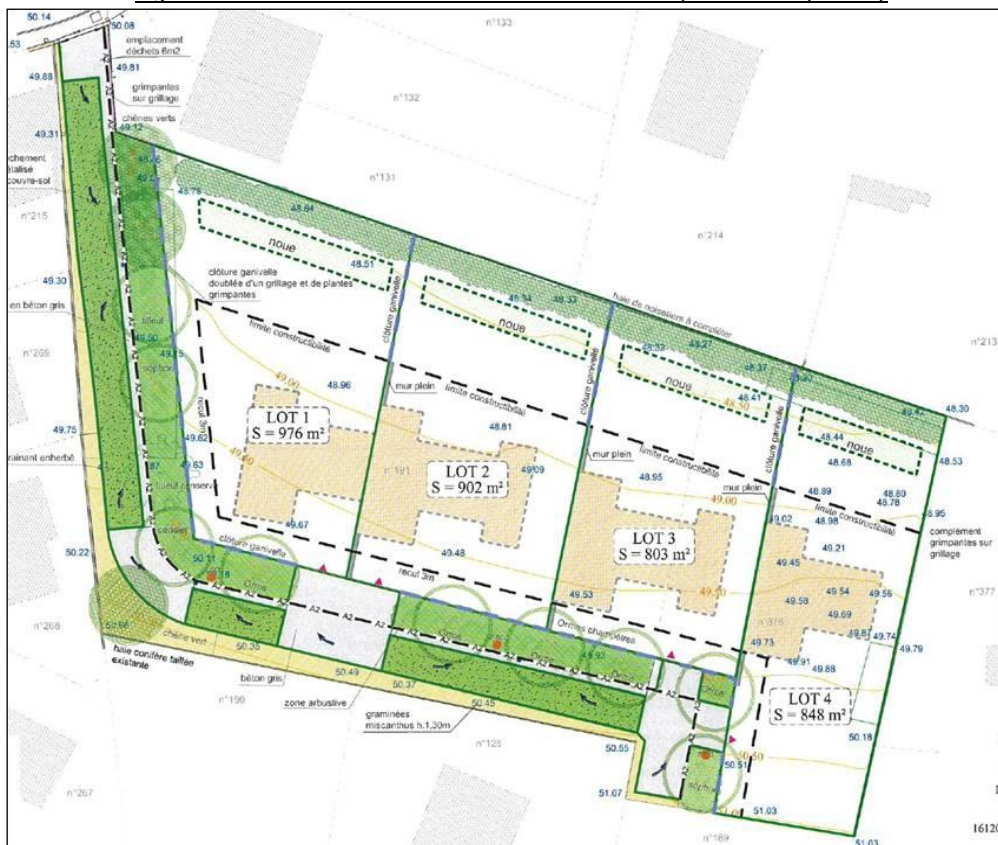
Extrait du plan de composition (source : Maître d'Ouvrage)
